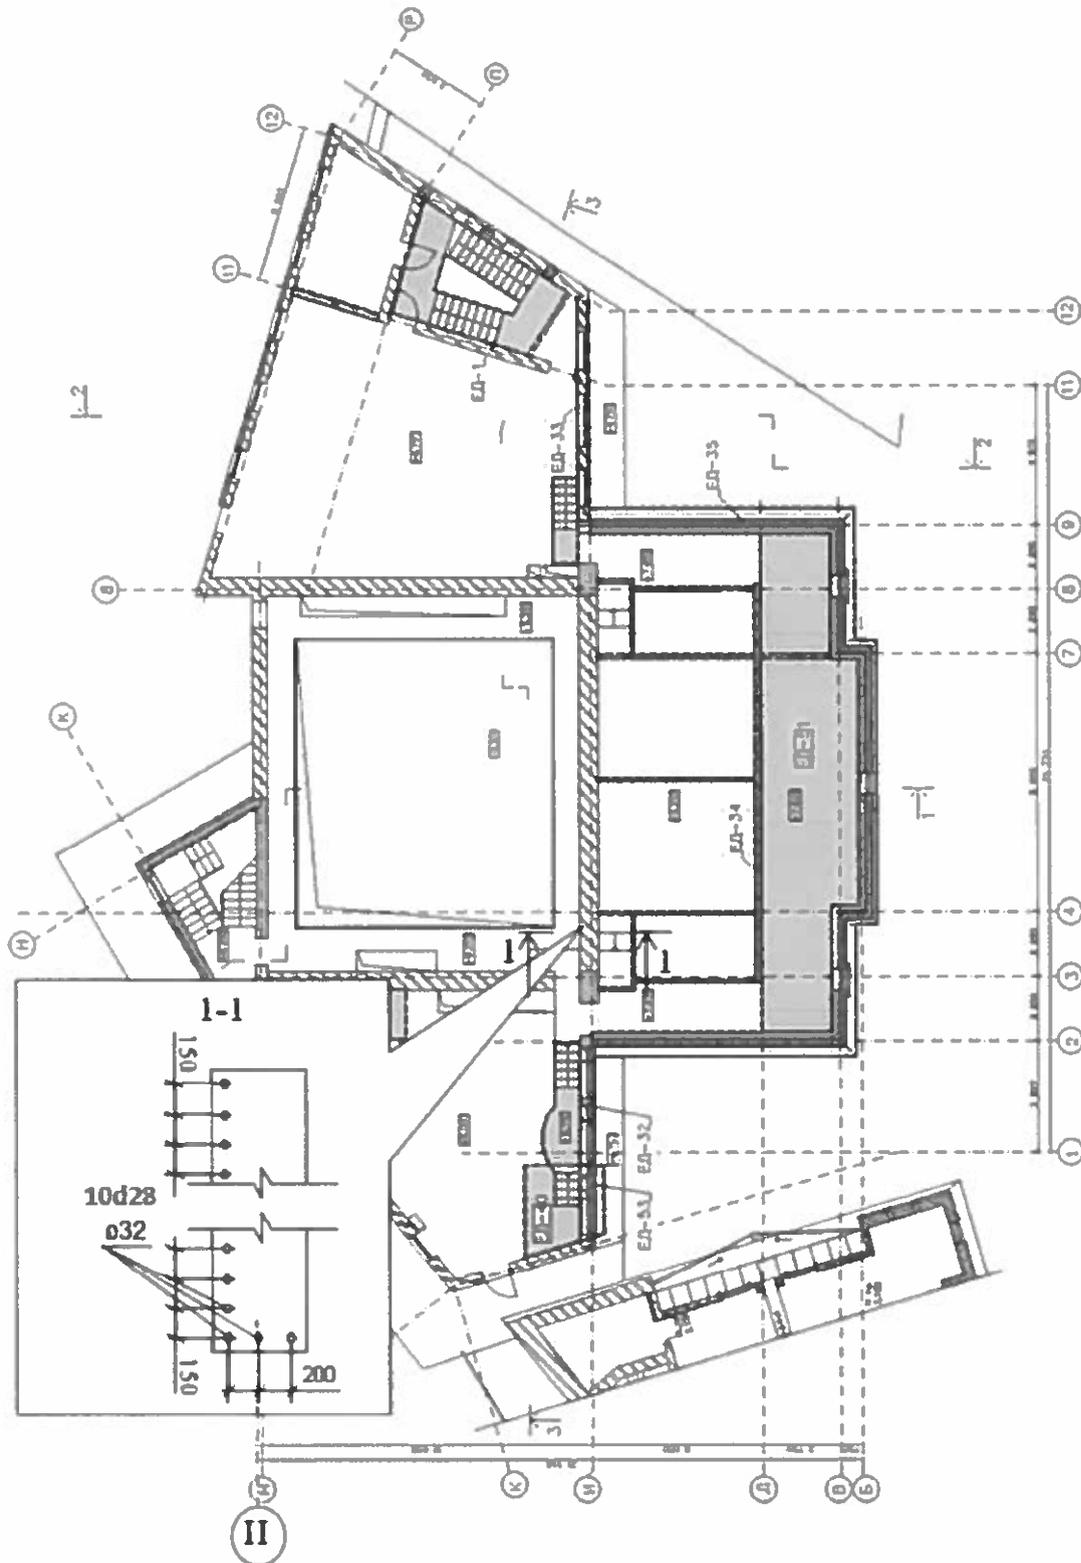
План будівлі з місцем визначення параметрів армування балки портала сцени по осі ІІ на відм. +7.700 з схематичним зображенням знайденої арматури
